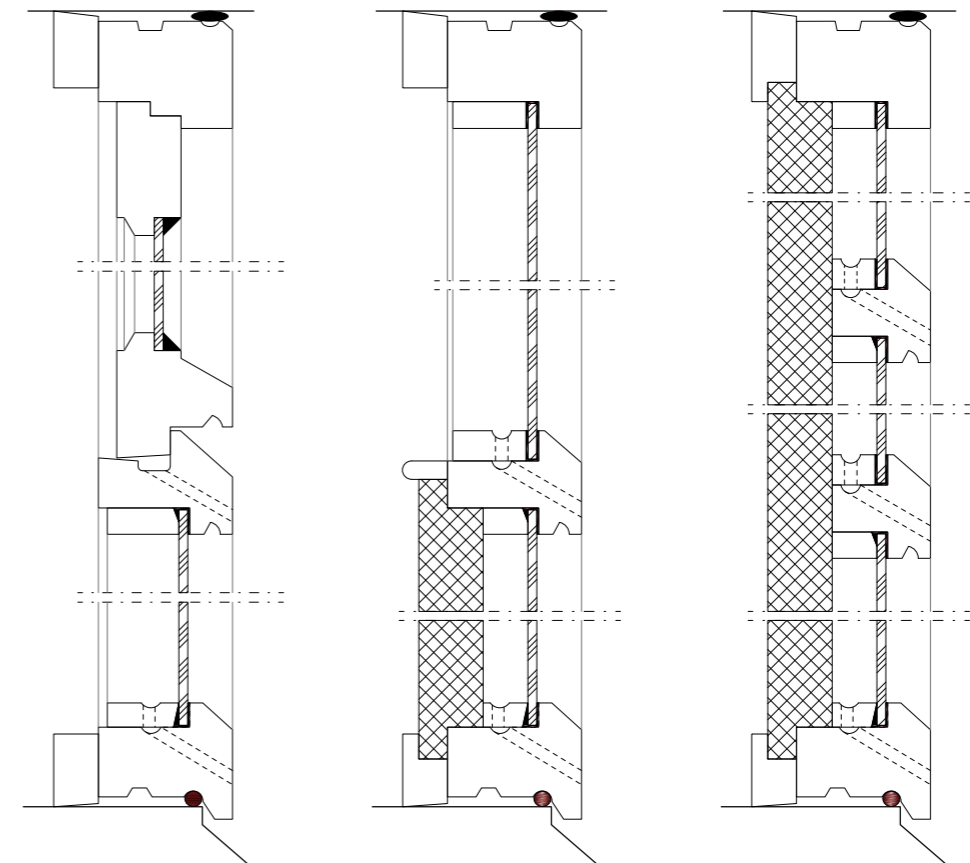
Coupes type des panneaux de façade; différents exemples avec ou sans panneau isolant.
